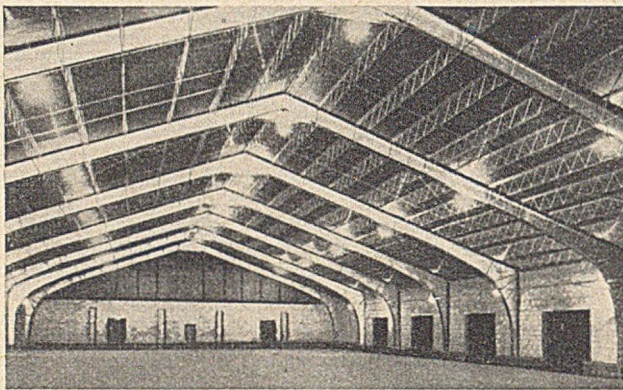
Sporthalle mit geschweißter Dachkonstruktion und Ziegel-Innenwänden. Der Gesamtraum beträgt 27,40 · 54,85 m.
